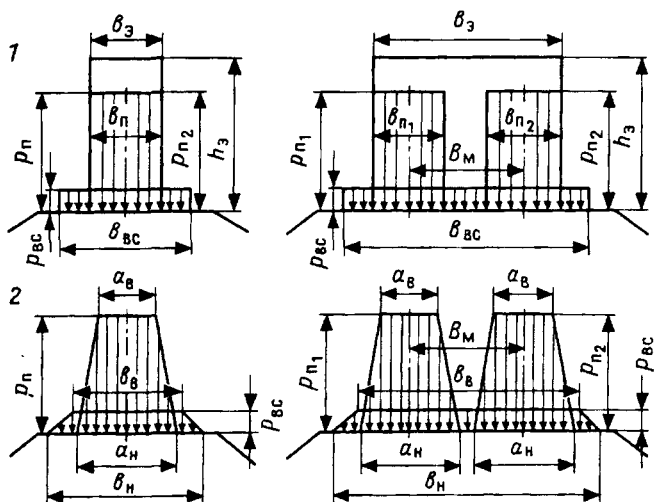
Эпюры нагрузок на ОП: 1 — прямоугольные;
